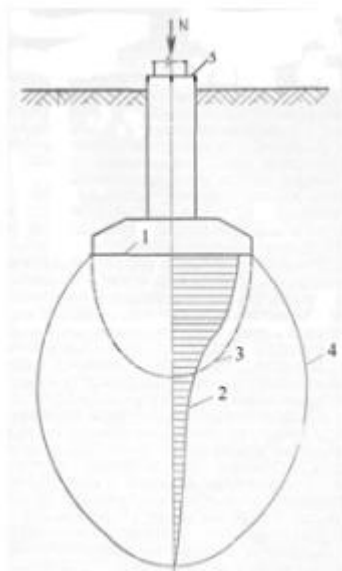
Основание здания: 1 – подошва фундамента, 2 – эпюра распределения вертикальных напряжений в грунте, 3 – зона наибольших напряжений, 4- граница области напряжений, 5 – обрез фундамента.
